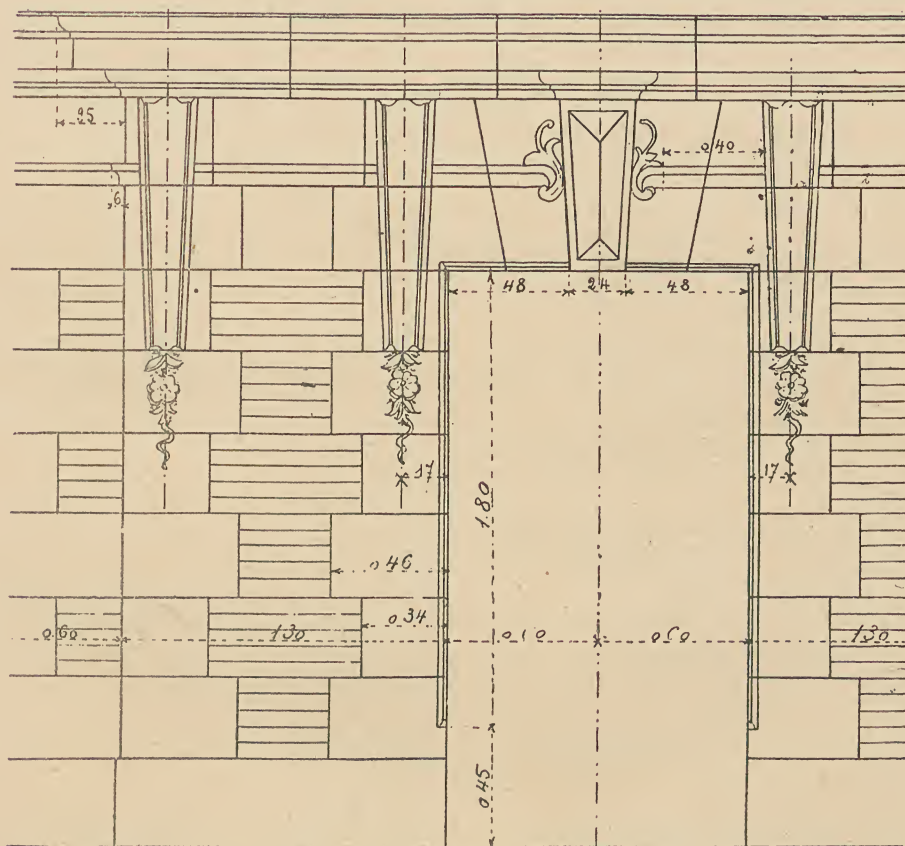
Détail d'une baie au 6<sup>e</sup> étage sur le boulevard.
